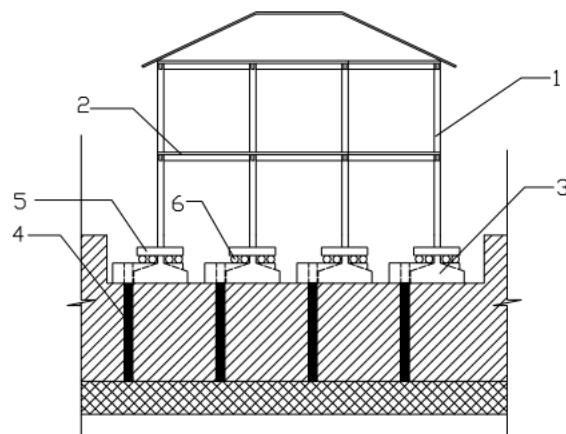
建筑物移位地下增层（先施工托换桩）示意图
